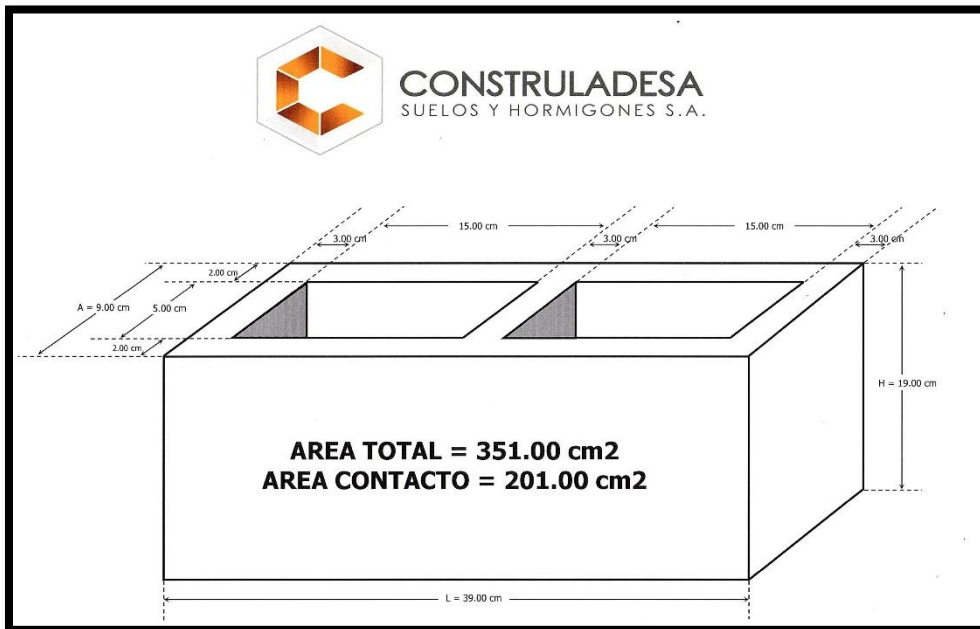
Propuesta de dimensiones de bloque de mampostería
